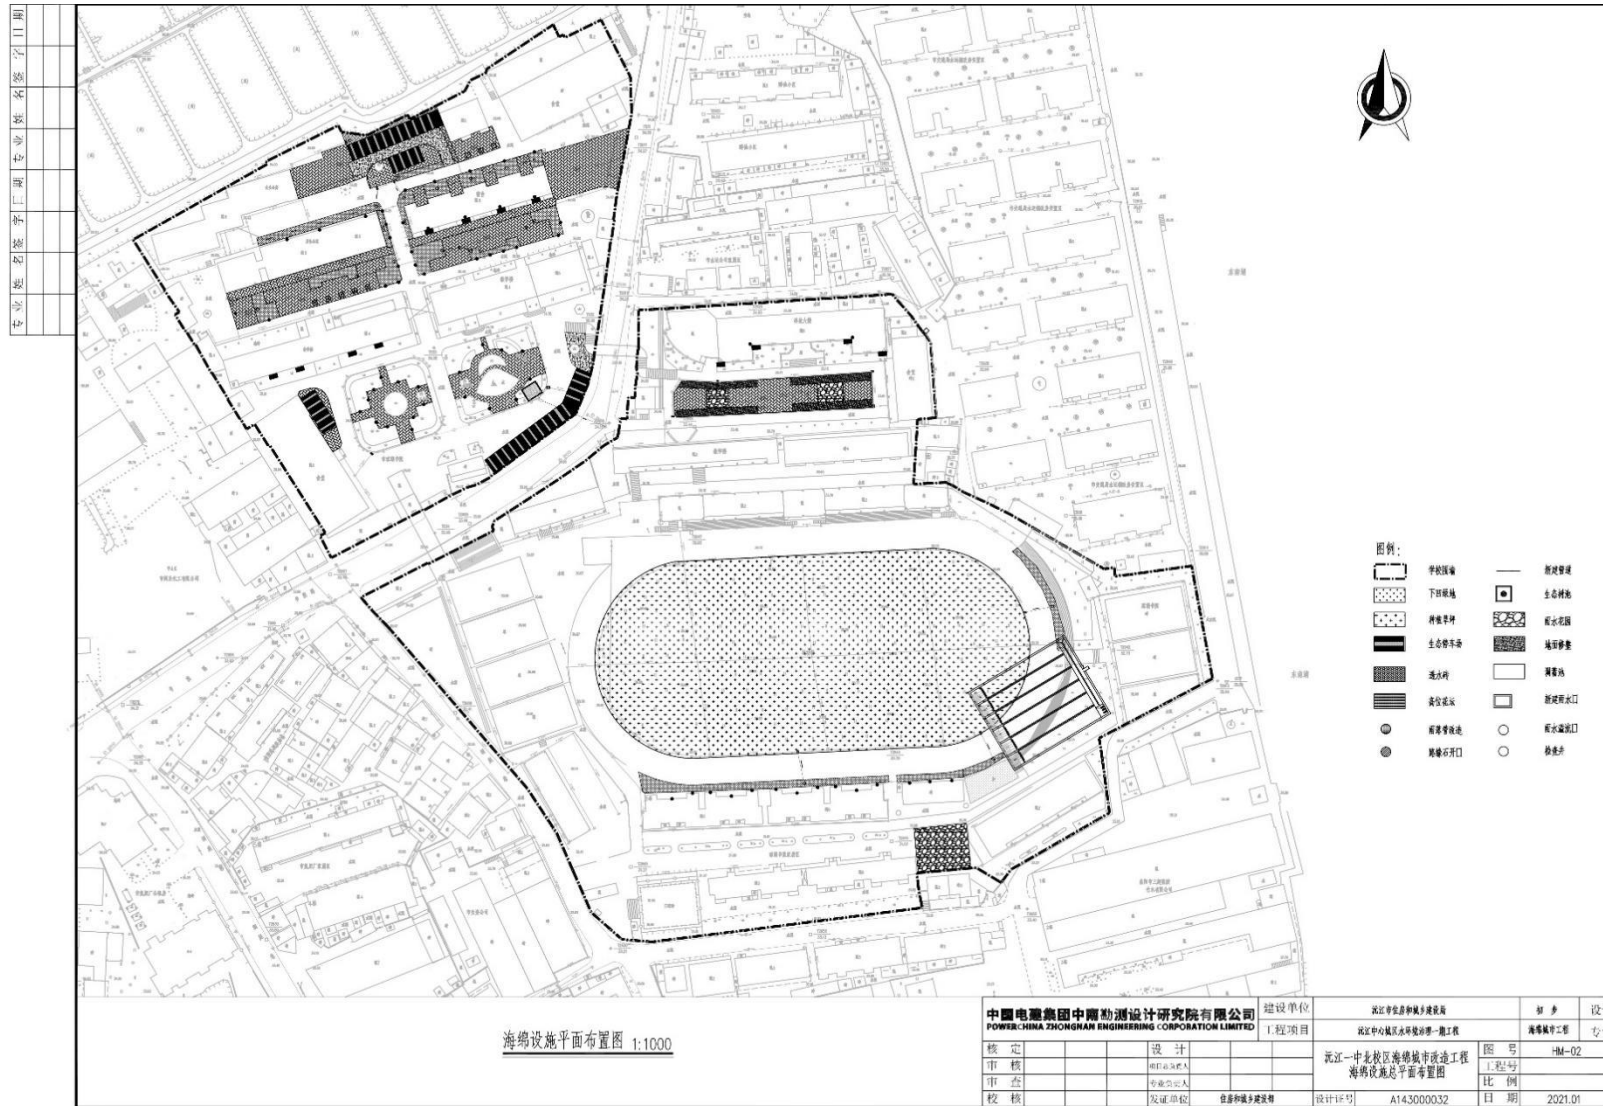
海绵城市示范小区设计总平面布置图
